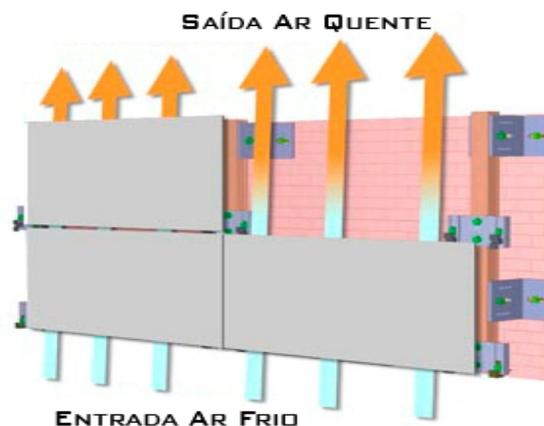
Ilustração Sistema de Fachada Ventilada (renovação do ar)
